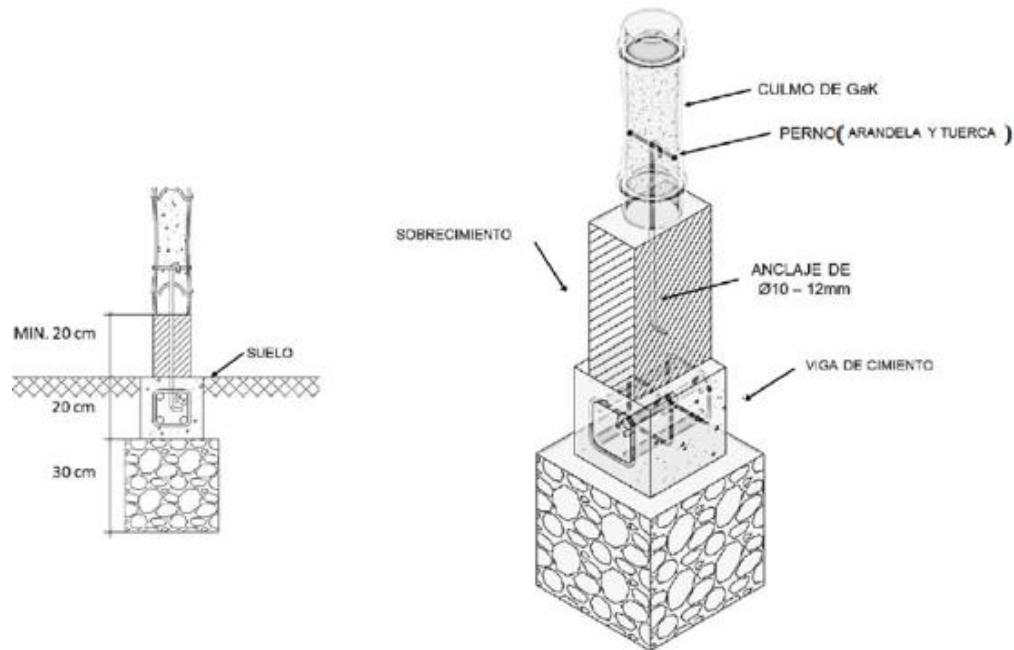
Detalle de apoyo de columnas GaK en sobrecimiento
